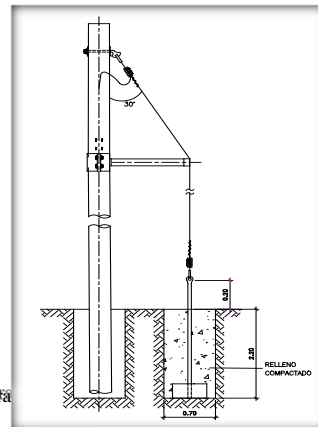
Calculo de bloqueta para retenida vertical<sup>42</sup>
